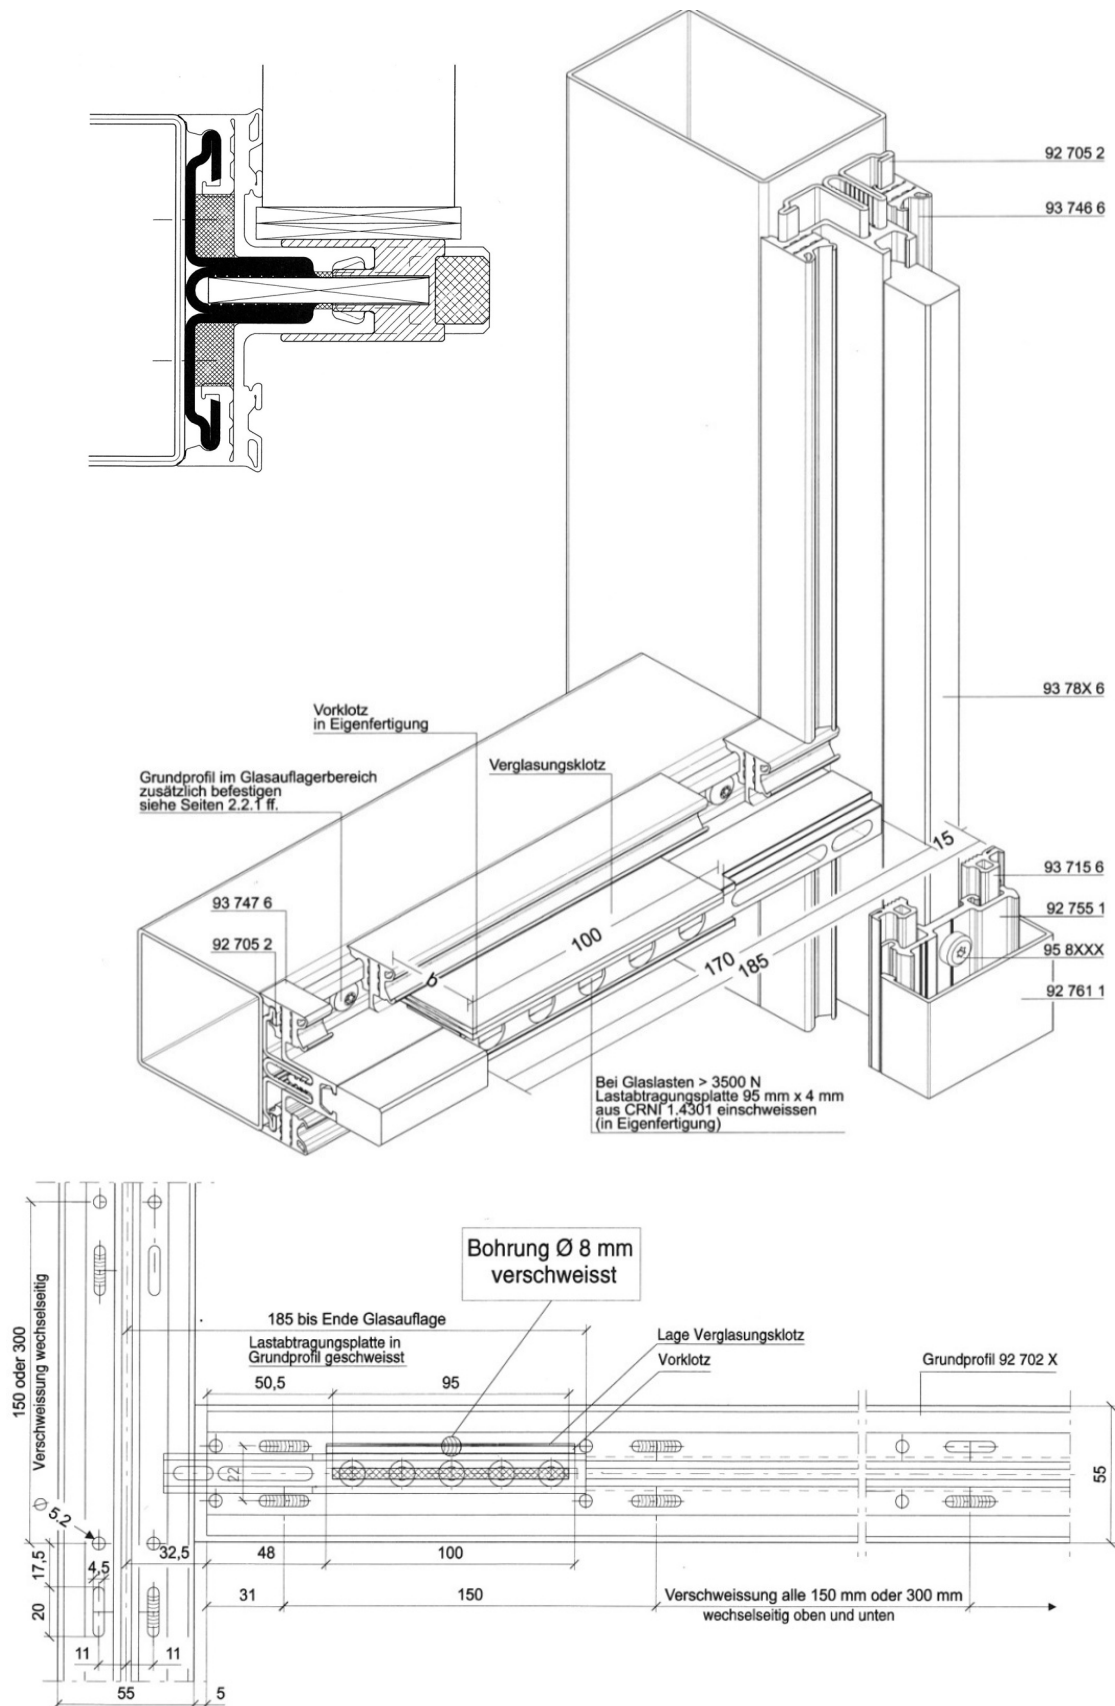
Grundprofil geschweißt, Glasaufleger mit Lastabtragungsplatte befestigt.
